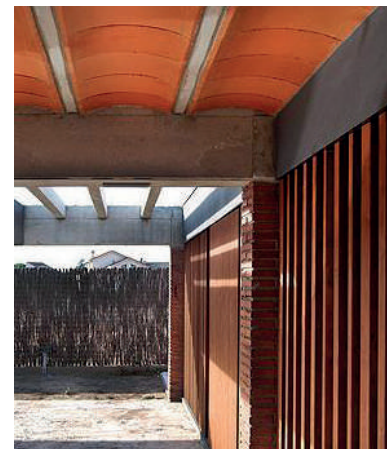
MATERIALES APARENTES CUBIERTA. Fuente: (www.arquitecturaviva.com, 2016)
